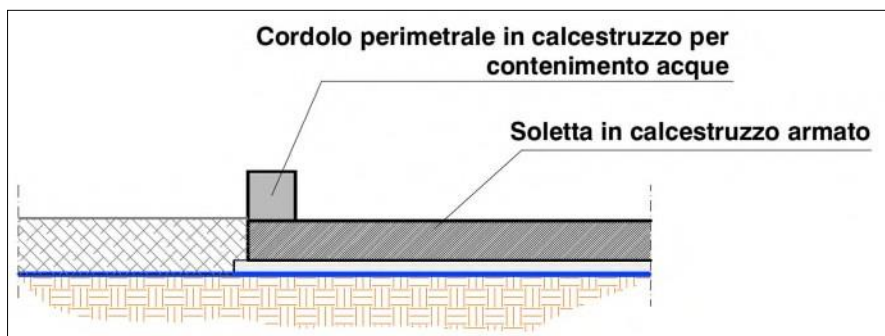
Schema di preparazione delle aree Piste cantiere e Piazzale
